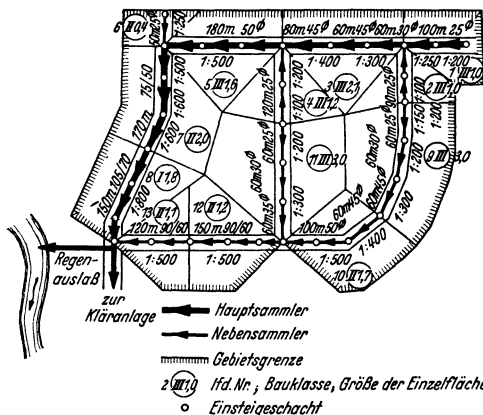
Lageplan zum Summenlinienverfahren. (Nach KEHR.)
